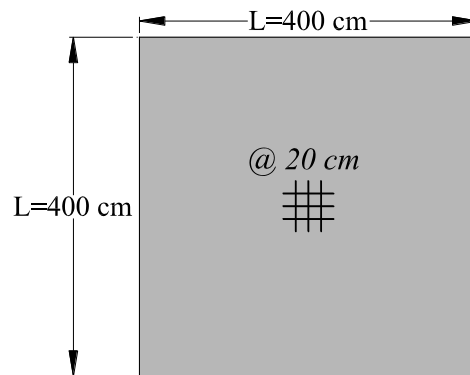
Vista en planta de la losa cuadrada simplemente apoyada
